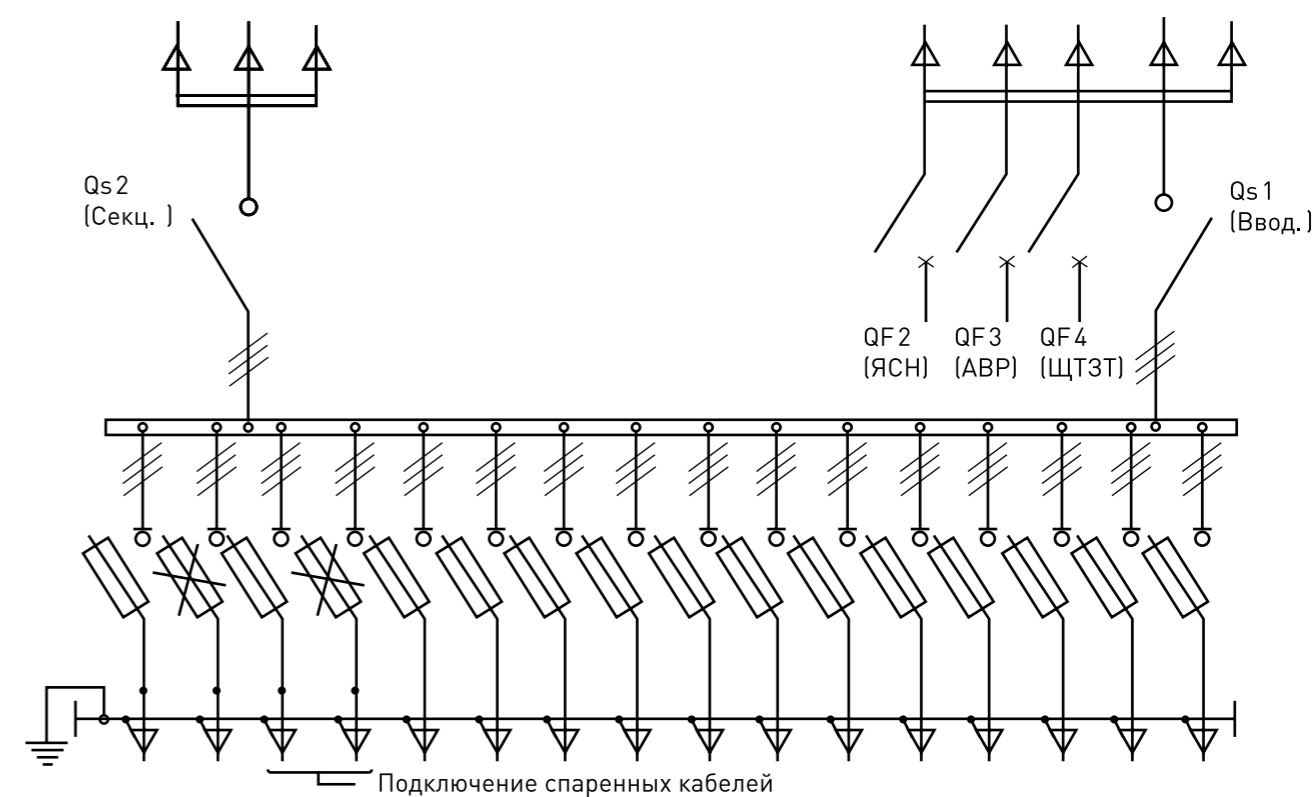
Схема главных цепей ШРНН с вводными и секционными выключателями нагрузки
